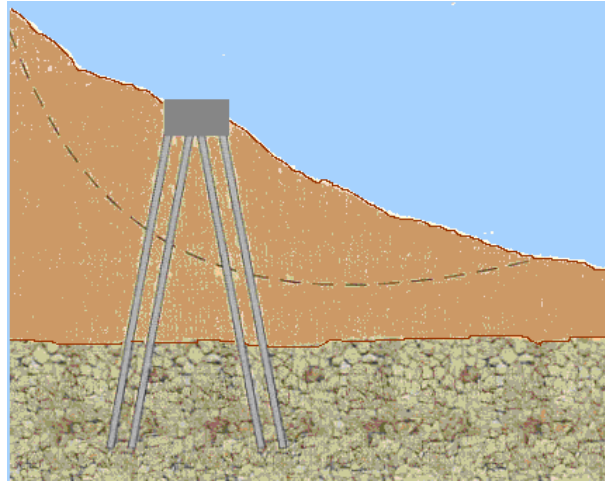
67. Proceso constructivo de pilotes colados in situ.
